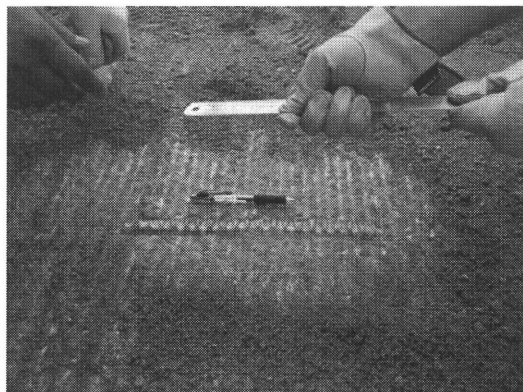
鉄筋の損傷 (切削工1回目, 鉄筋①)
